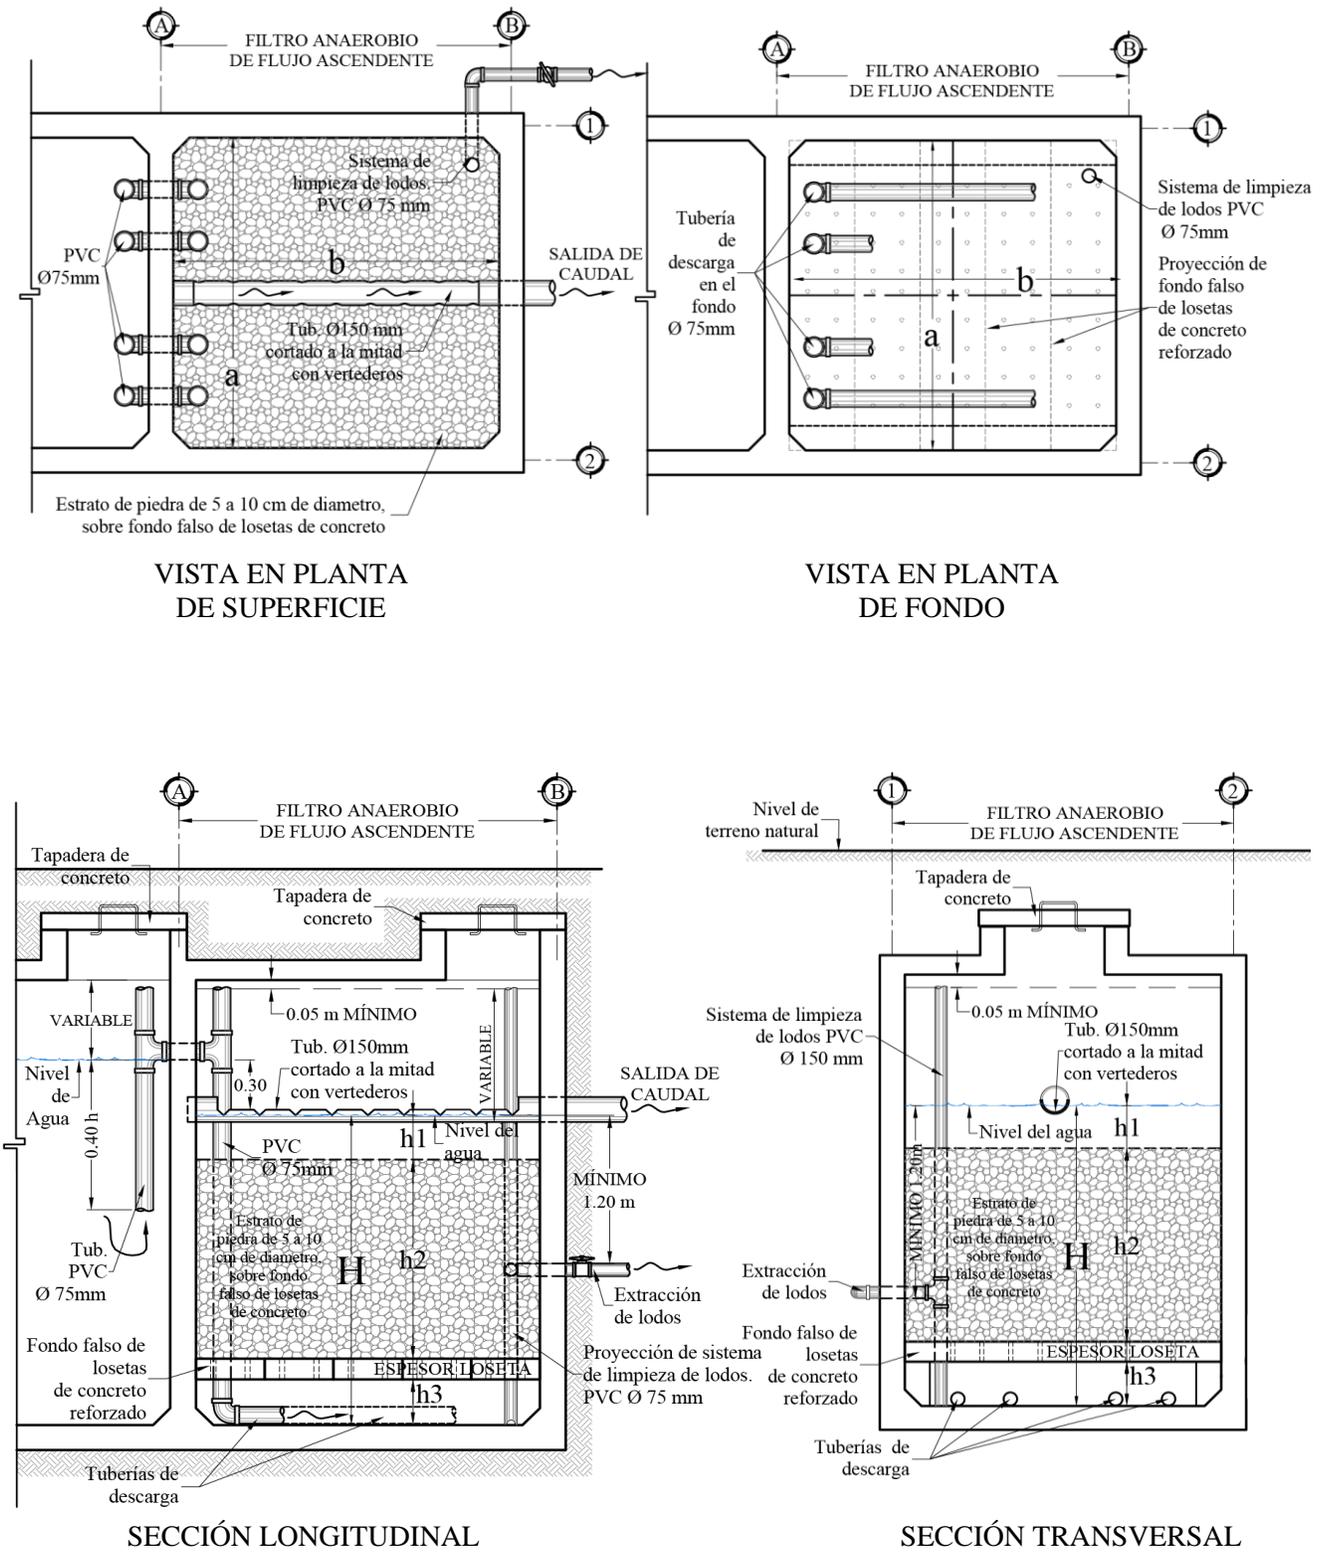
Detalles constructivos de un FFAA. Construido a continuación de un tanque séptico
